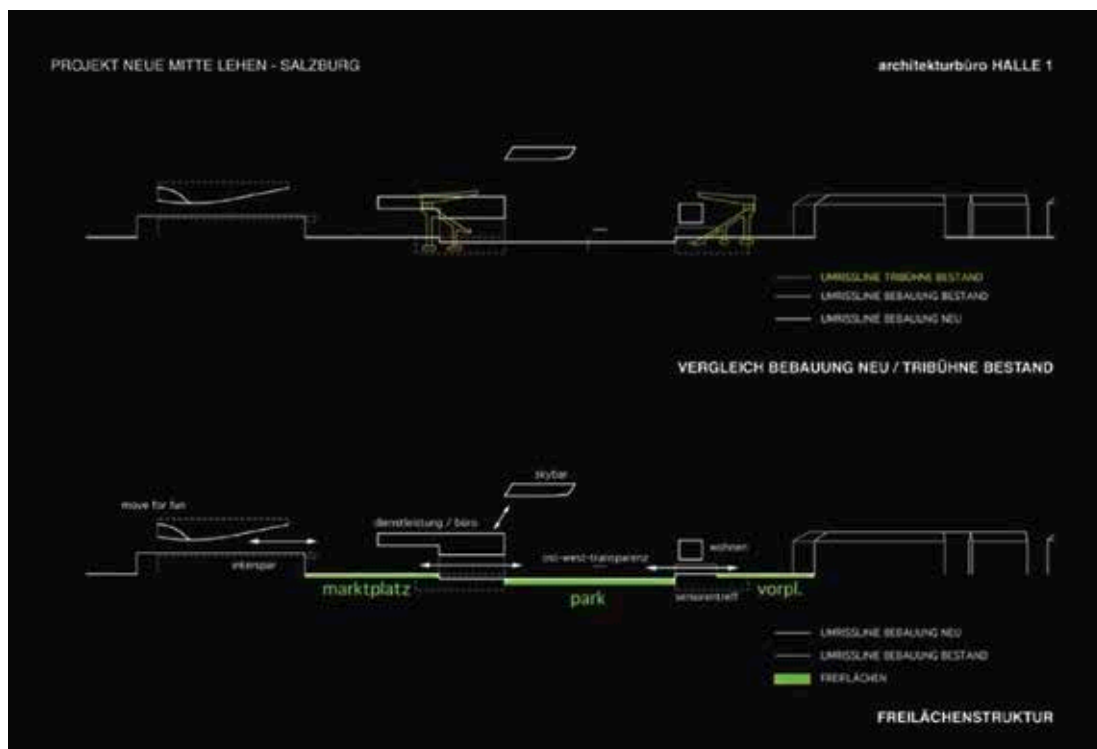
Projekt Neue Mitte Lehen – Flächenstruktur
